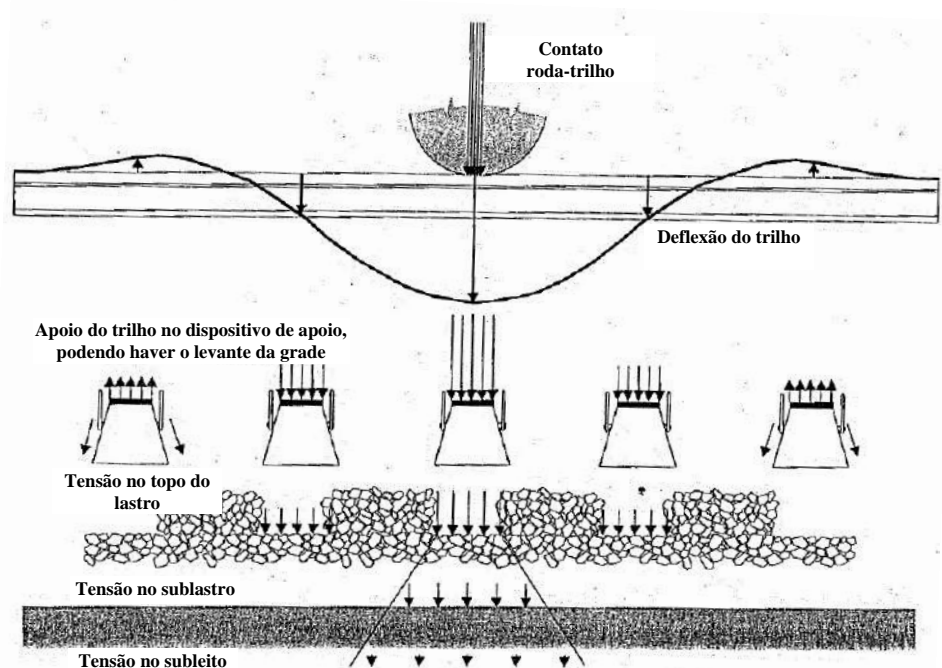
Distribuição típica de tensões entre as camadas do pavimento ferroviário
